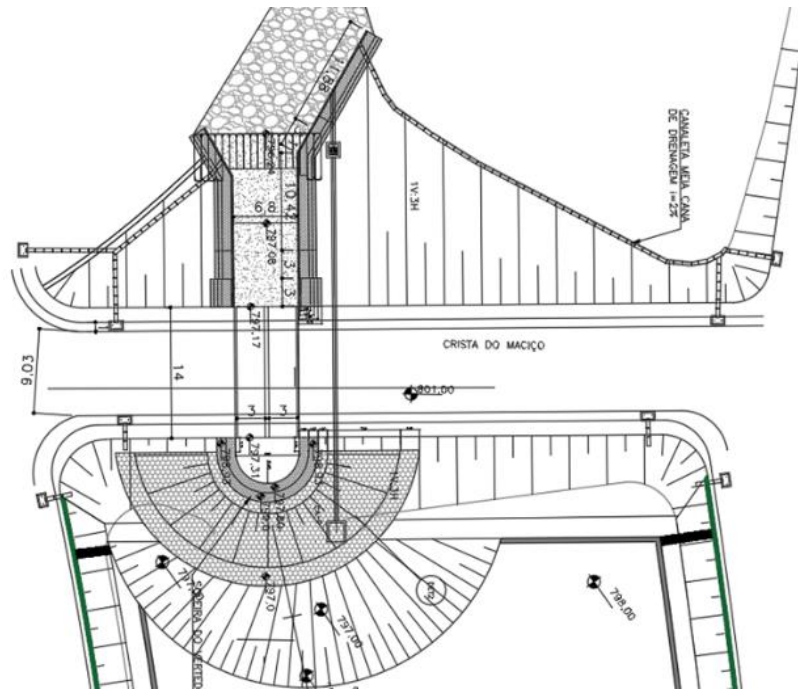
Planta com arranjo geral da barragem com vertedor na ombreira esquerda - sem escala.
